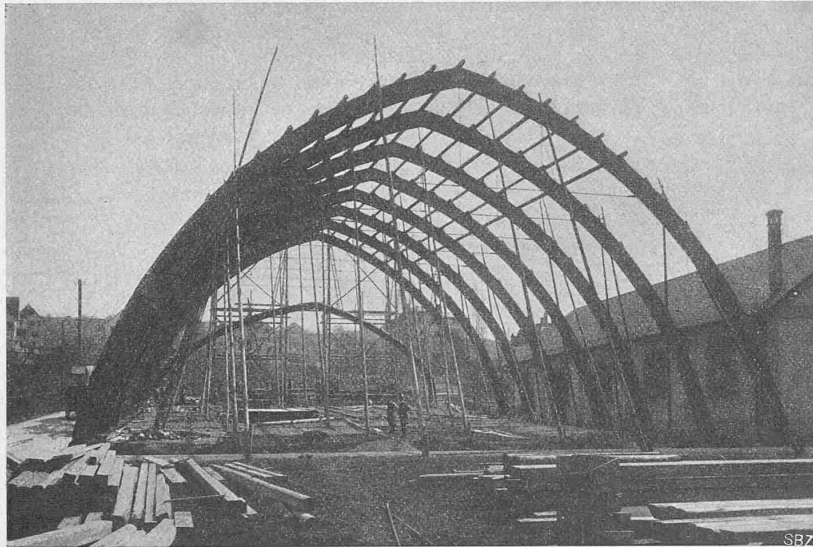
Sängerfesthalle Küssnacht bei Zürich 1911. — Stützweite 30 m.
